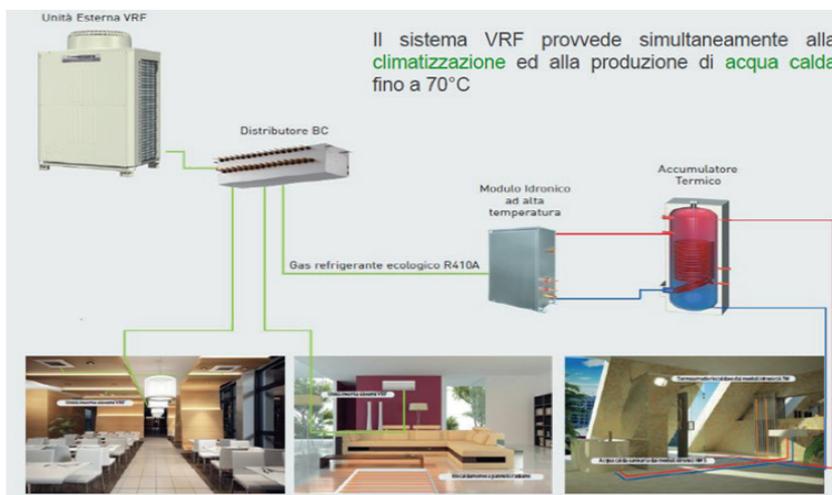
schema di impianto VRV-VRF misto (fonte: Mitsubishi)
